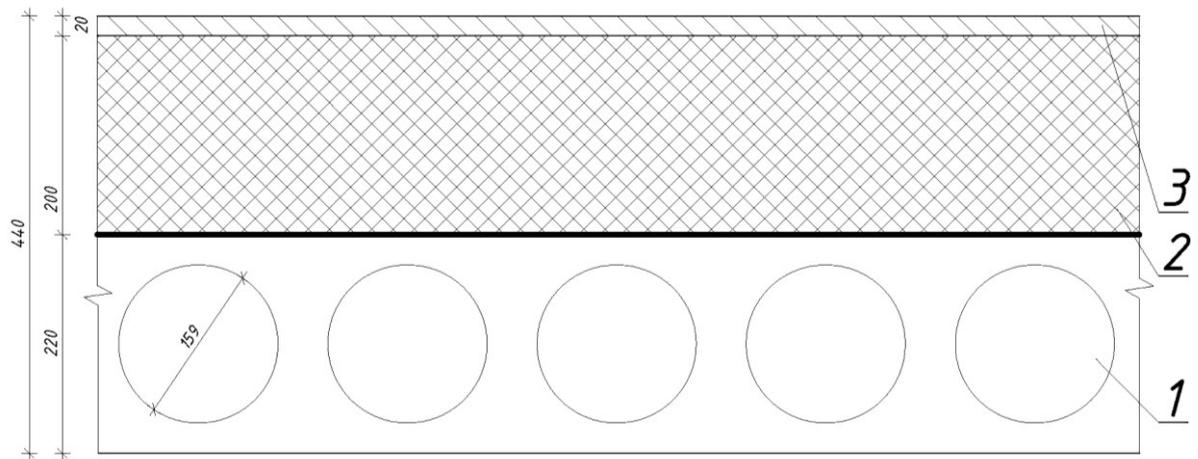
Конструкція перекриття над неопалювальним горіщем.
